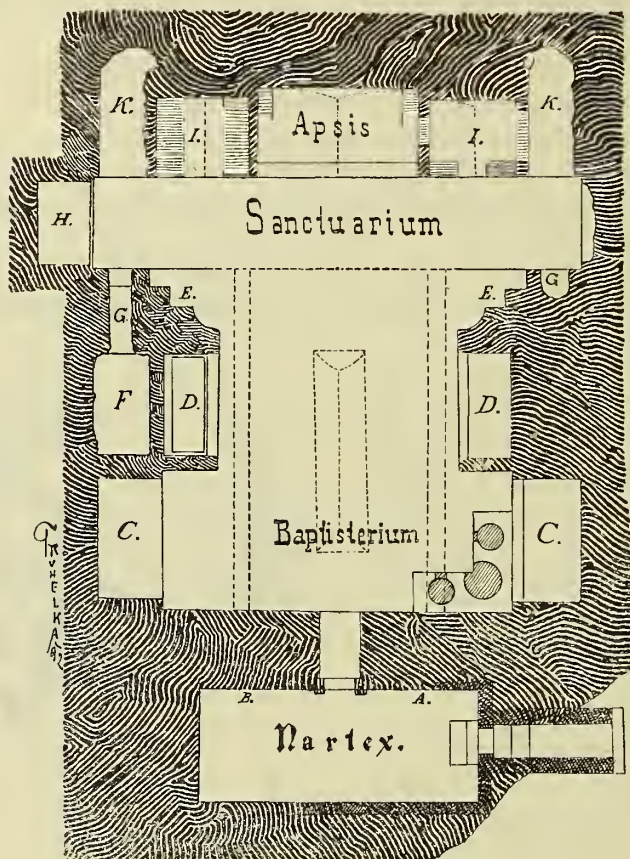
Grundriss der unterirdischen Kirche in Jajee.
